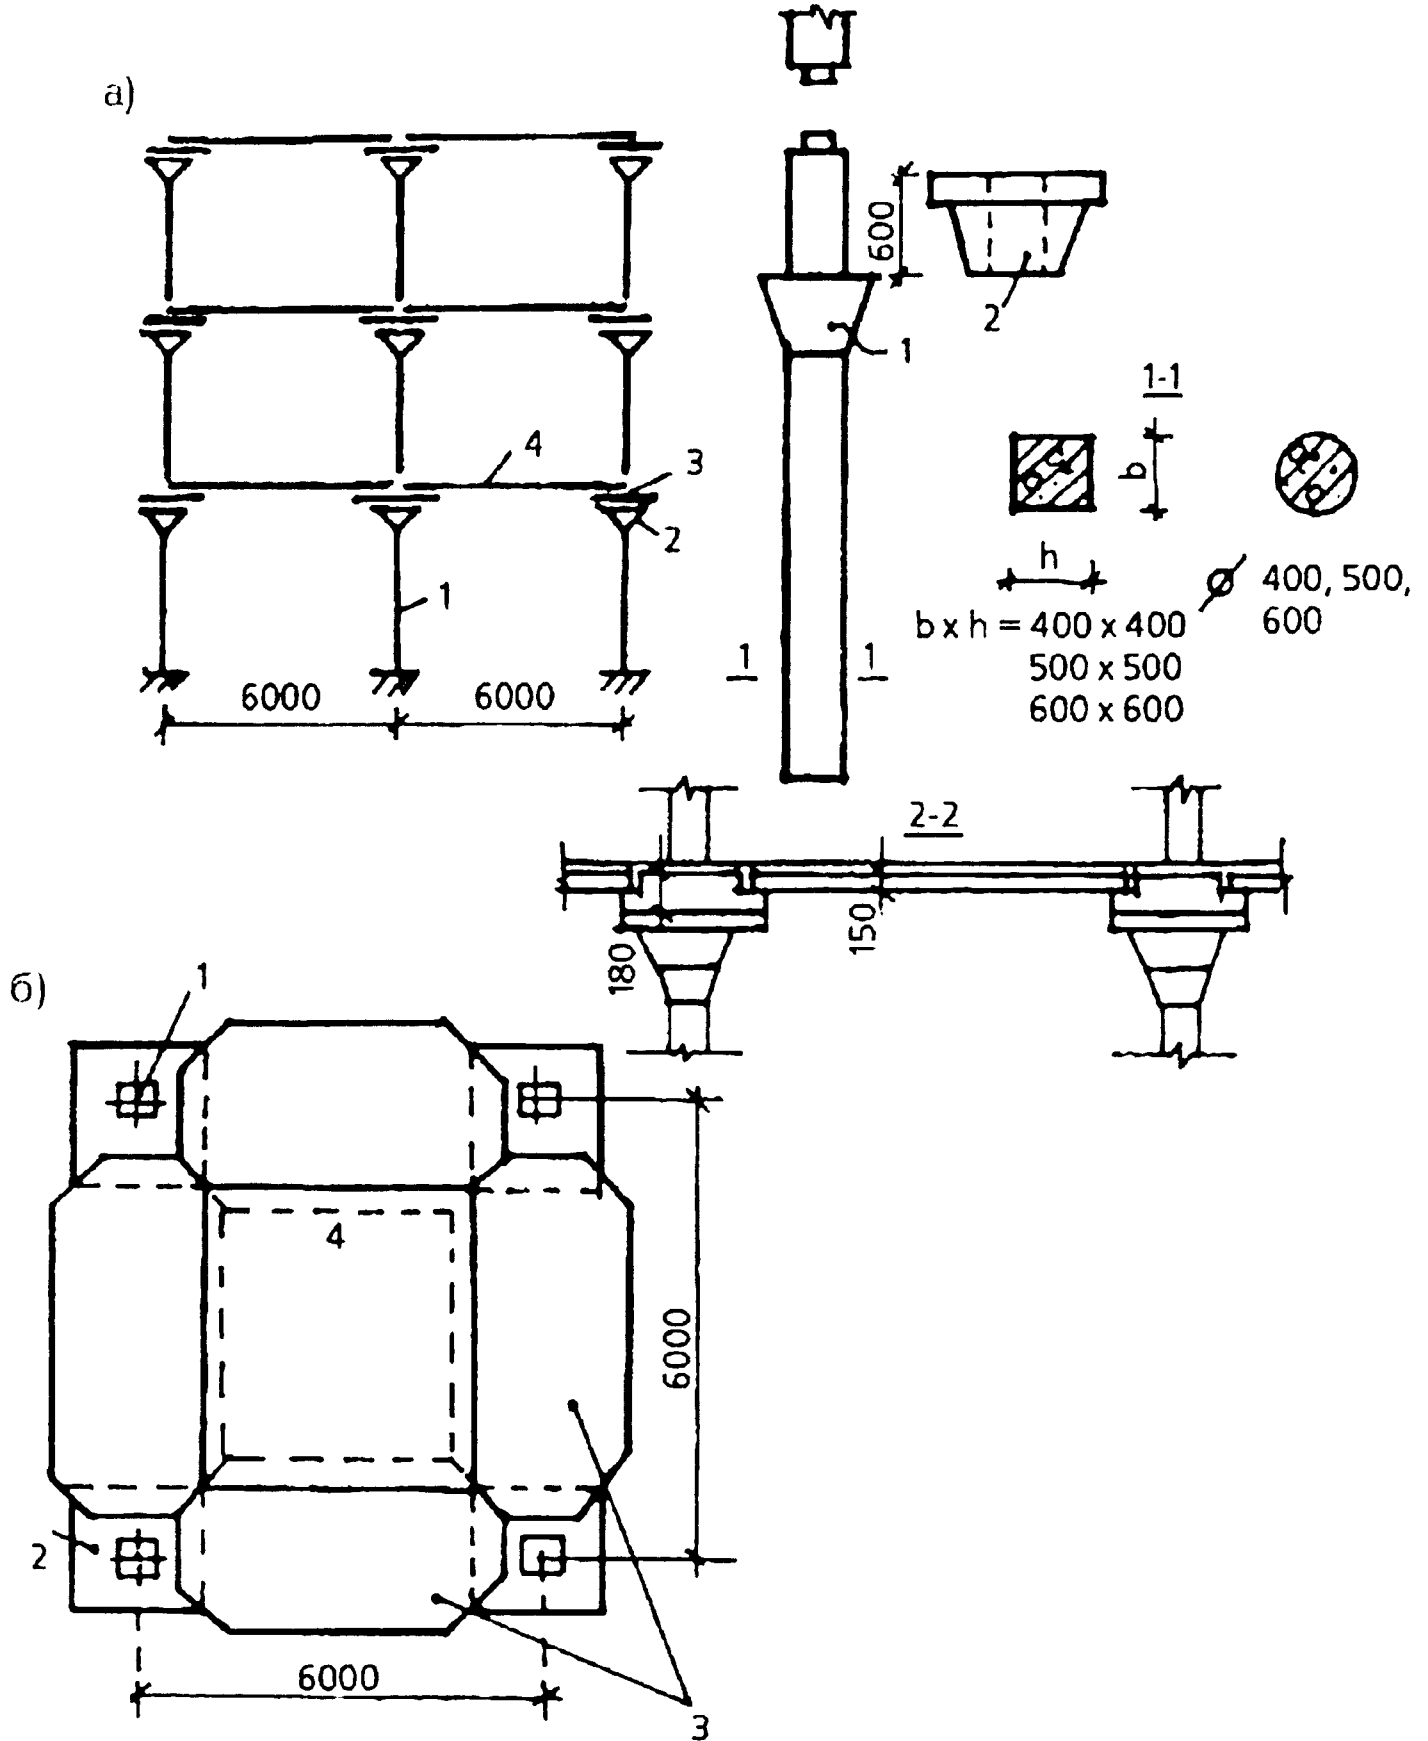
Безбалочный каркас. Элементы: а - схема поперечной рамы каркаса; б - план конструктивной ячейки; 1 - колонна; 2 - капитель; 3 - межколонные плиты; 4 - пролетная плита
